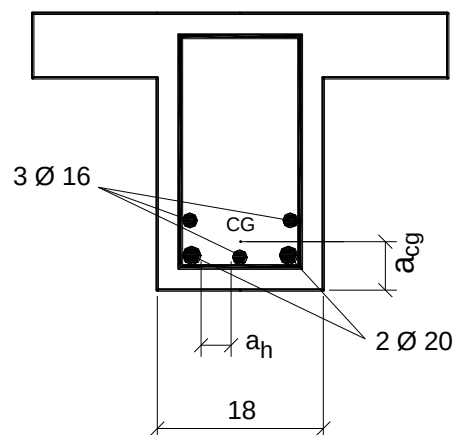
Detalhamento da armadura longitudinal na seção transversal.
